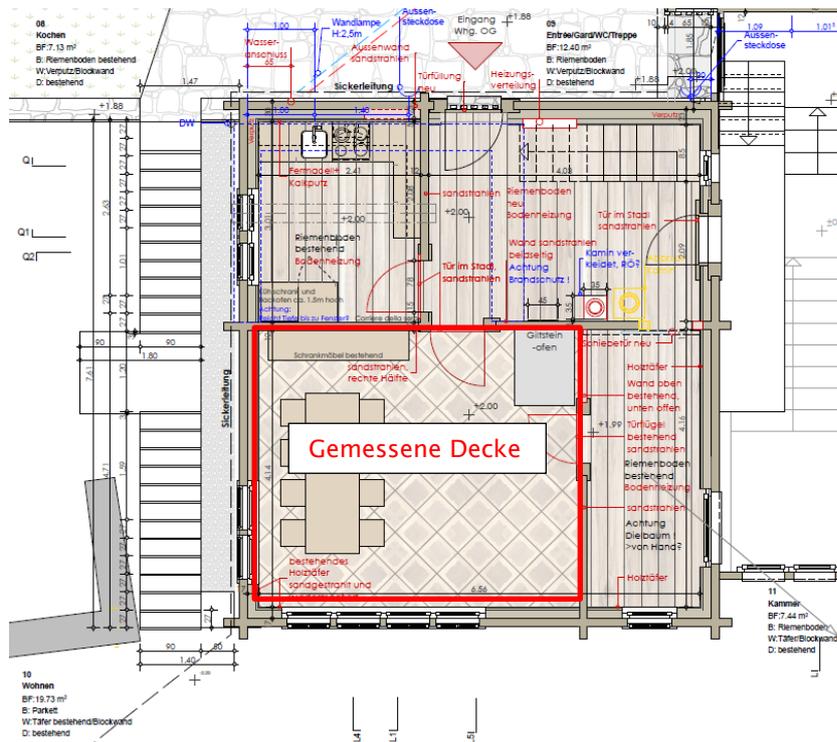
Unmassstäblicher Planausschnitt des Grundrisses 1.OG - Wohneinheit 2 mit Messtelle
